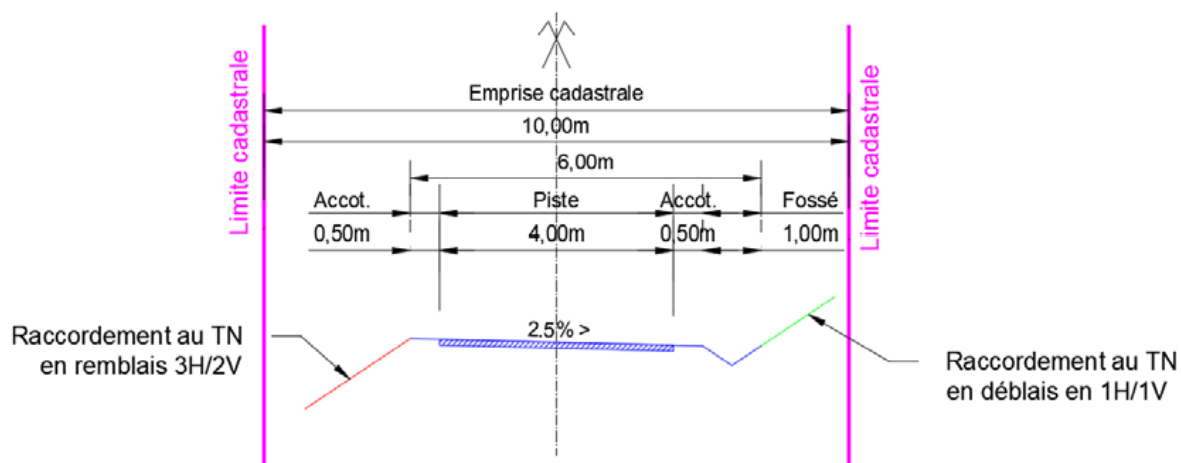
Profil en travers de la piste d'accès (source : BECIB)
